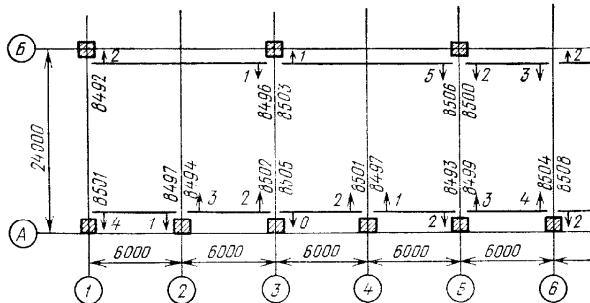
Исполнительная схема положения подкрановых балок (около осей — отметки верха балок; стрелками показано направление смещения конца балок, цифрами около них — отклонения, мм; проектная отметка верха балок 8,500)
